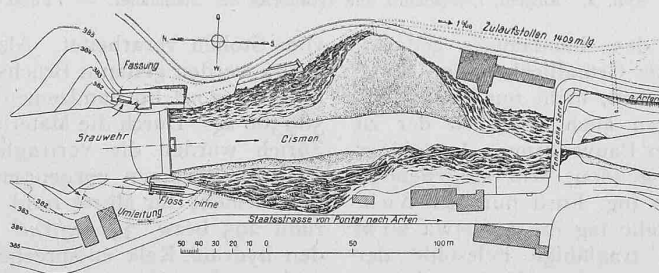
Lageplan der Wehrstelle. — Masstab 1:4000.
